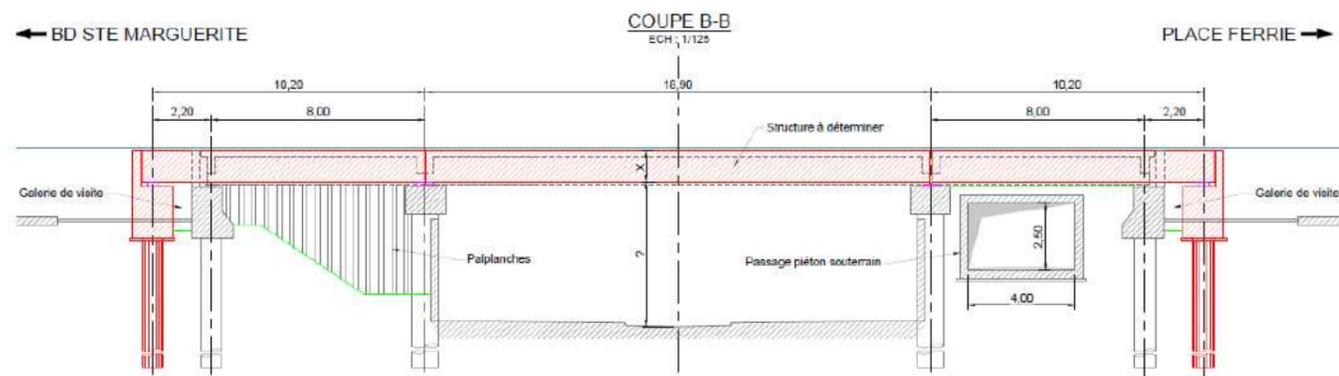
Coupe en travers de l'ouvrage proposé pour le franchissement de l'Huveaune
